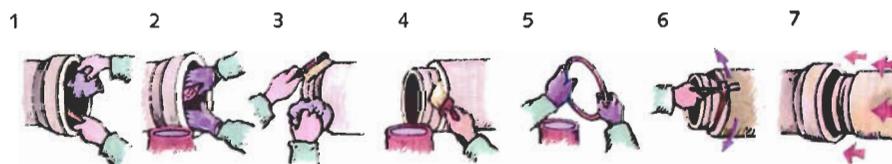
b Pasos a seguir en el montaje de juntas deslizantes
